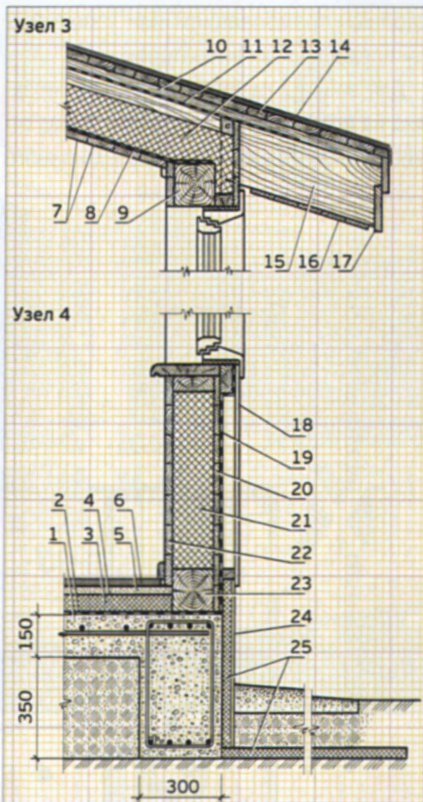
Узлы 3 и 4 (см. рис. 2): 1 — монолитная железобетонная плита; 2 — гидроизоляция; 3 — теплоизоляция; 4 — полиэтиленовая плёнка; 5 — выравнивающая стяжка; 6 — паркетная доска; 7 — чистовая подшивка потолка; 8 — пароизоляция; 9 — брус верхней обвязки; 10 — контробрешётка; 11 — гидроизоляция; 12 — теплоизоляция; 13 — деревянный настил; 14 — мягкая кровля; 15 — стропило; 16 — деревянная подшивка; 17 — лобовая доска; 18 — вагонка (сайдинг); 19 — паропроницающая плёнка типа «Тайвека»; 20 — тесовая обшивка; 21 — теплоизоляция; 22 — внутренняя обшивка; 23 — брус нижней обвязки; 24 — защитный слой; 25 — теплоизоляция.
